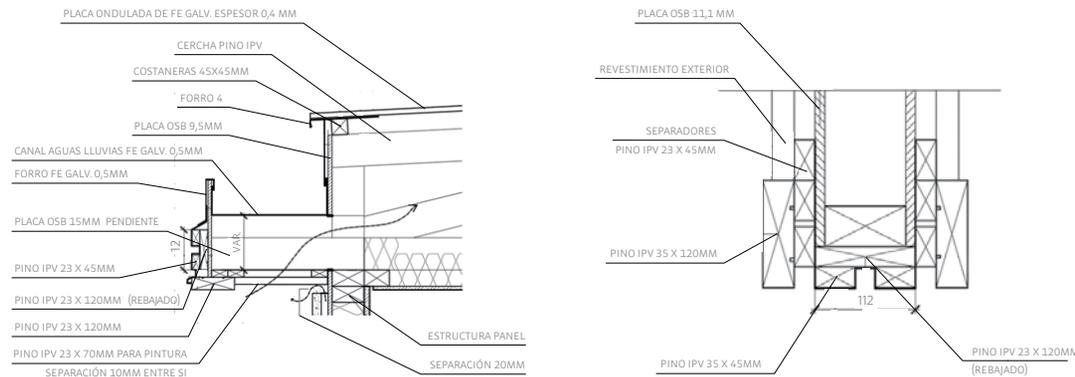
La planimetría del proyecto estructural es también usada para el montaje en obra de los componentes prefabricados.
